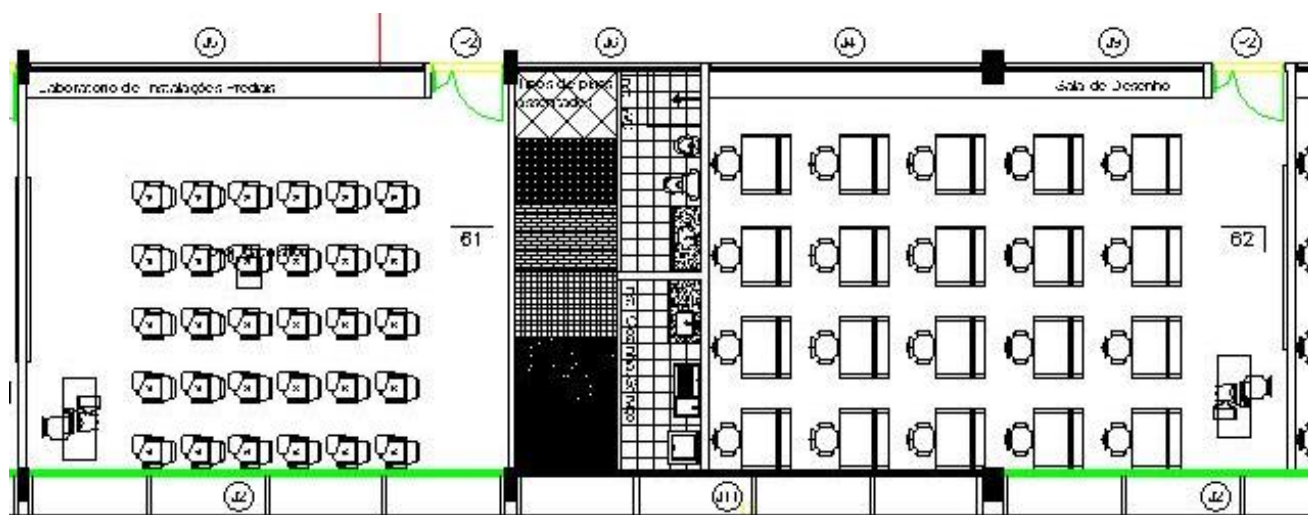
Planta Baixa do Laboratório de Instalações Prediais e Sala de Desenho.
